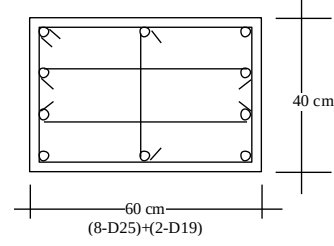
C çerçevesindeki kiriş ve yapısal olmayan beton duvarların boyutları
